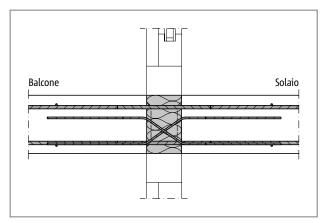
Schöck Isokorb® tipo DXT: sezione costruttiva; solaio monodirezionale
